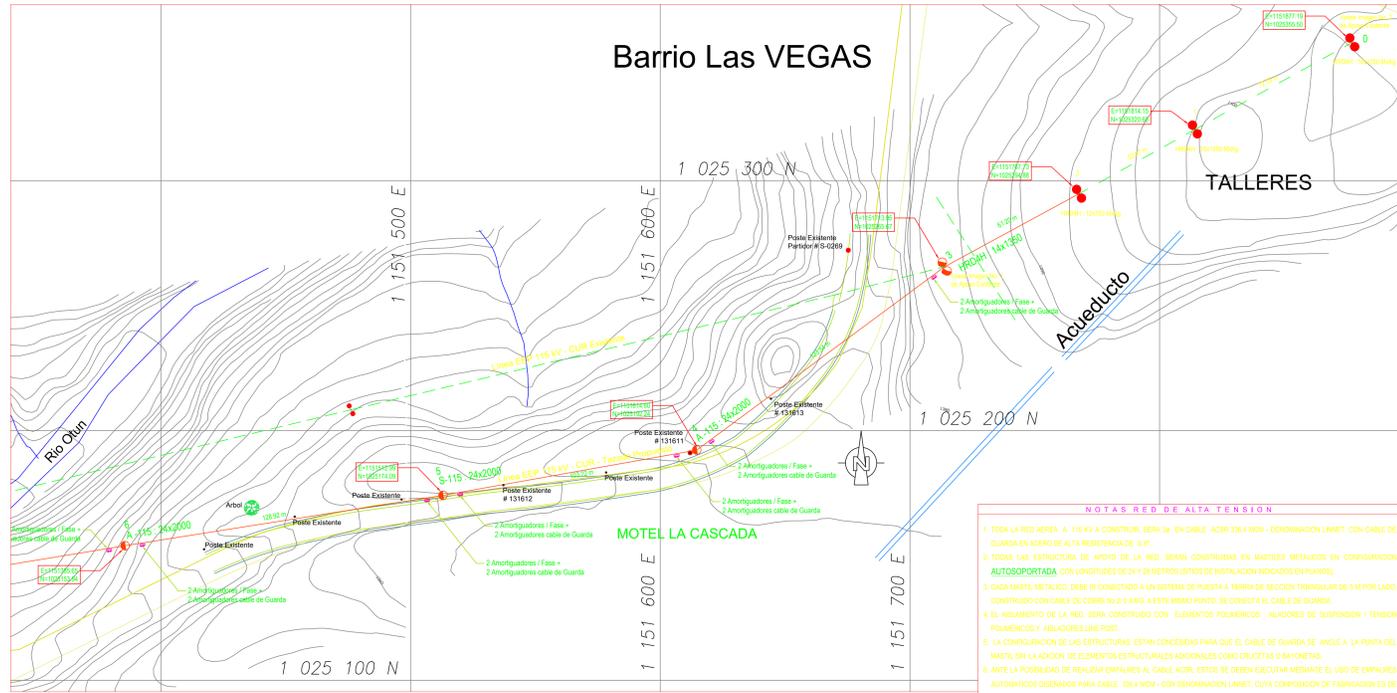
APOYO HRTD4 EXISTENTE
